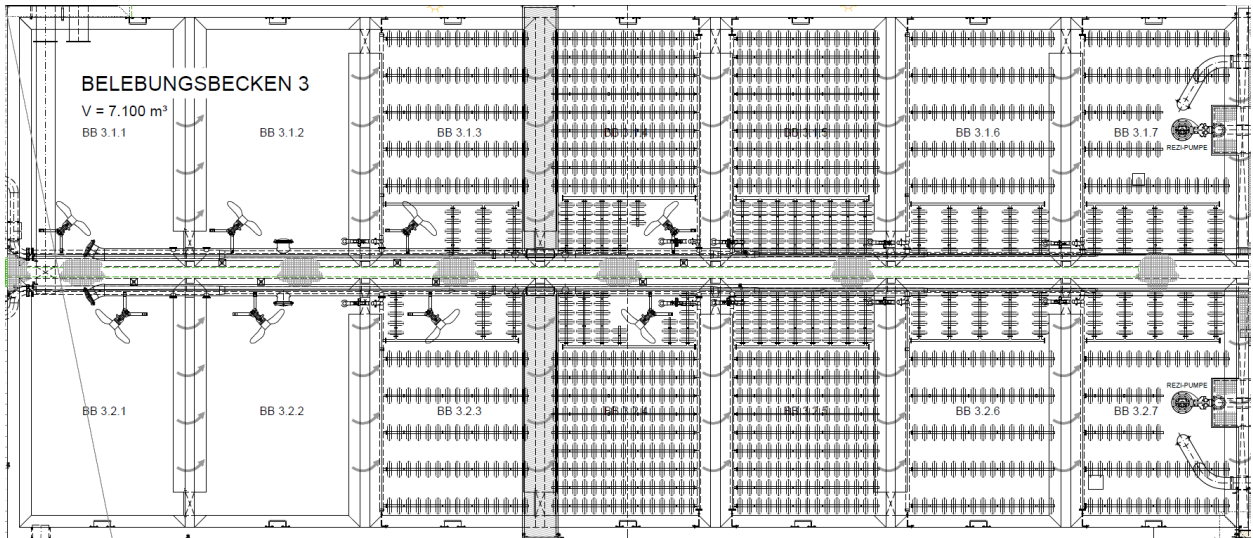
Draufsicht Belebungsbecken mit technischer Ausrüstung
